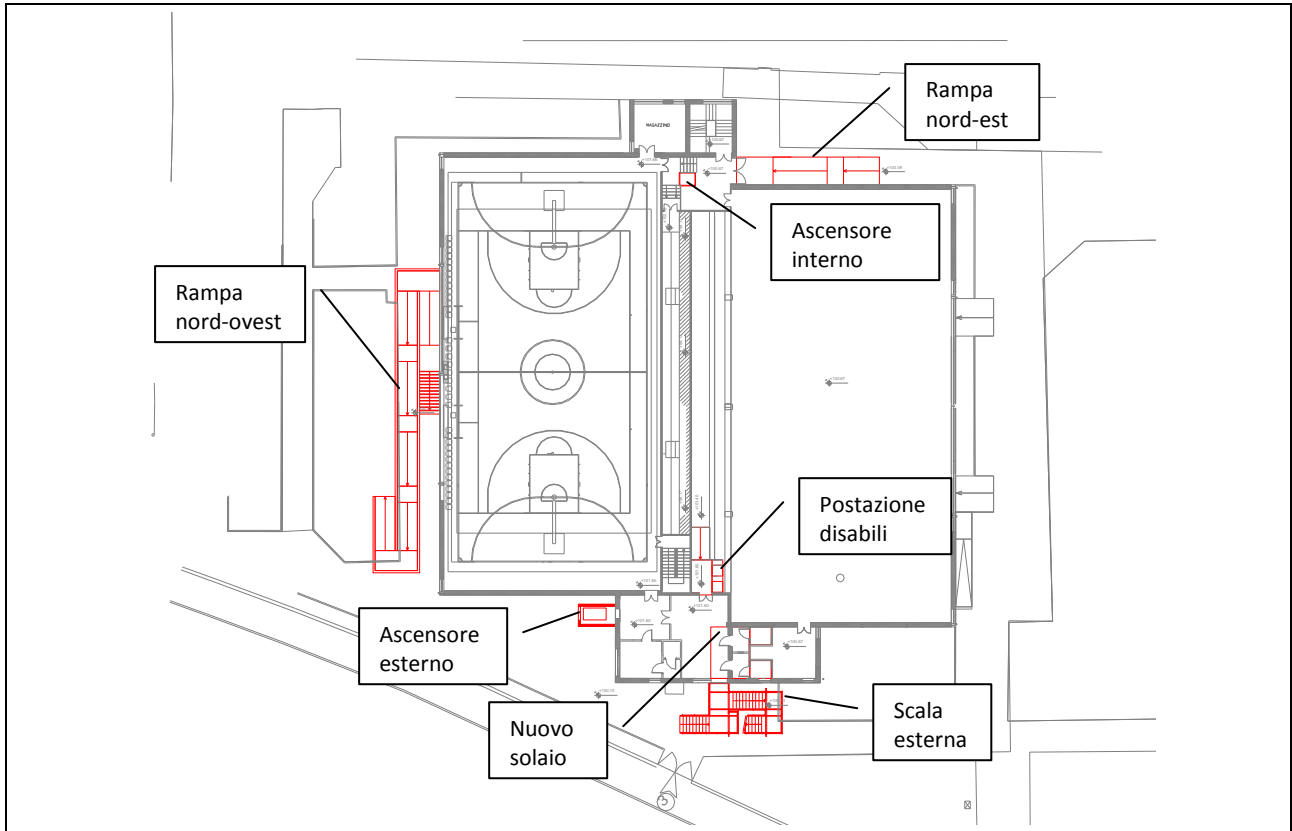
Pianta chiave piano terra con indicazione degli interventi in progetto
